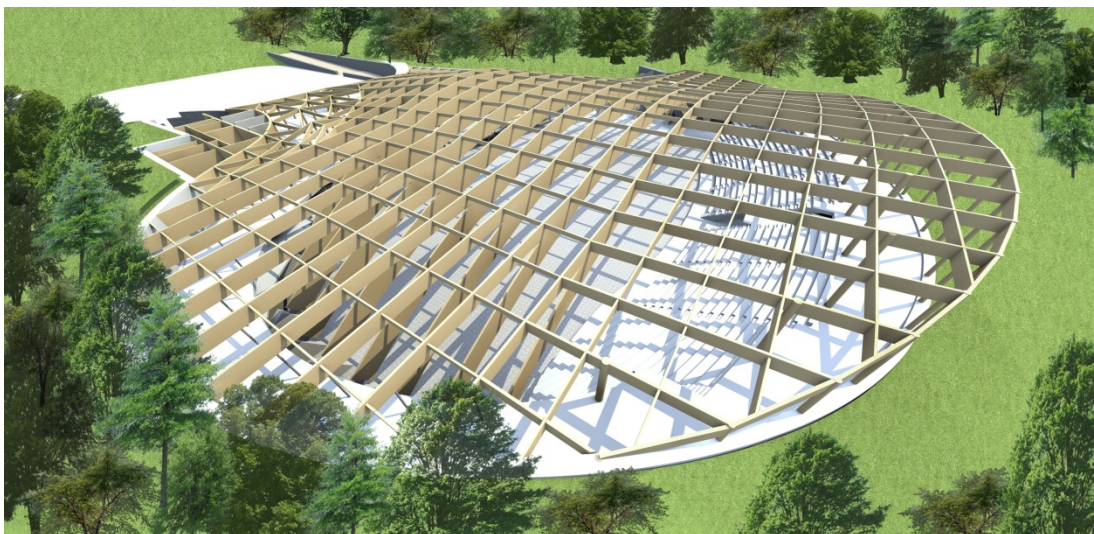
FASE DI CANTIERE – MONTAGGIO STRUTTURA DI COPERTURA 2
